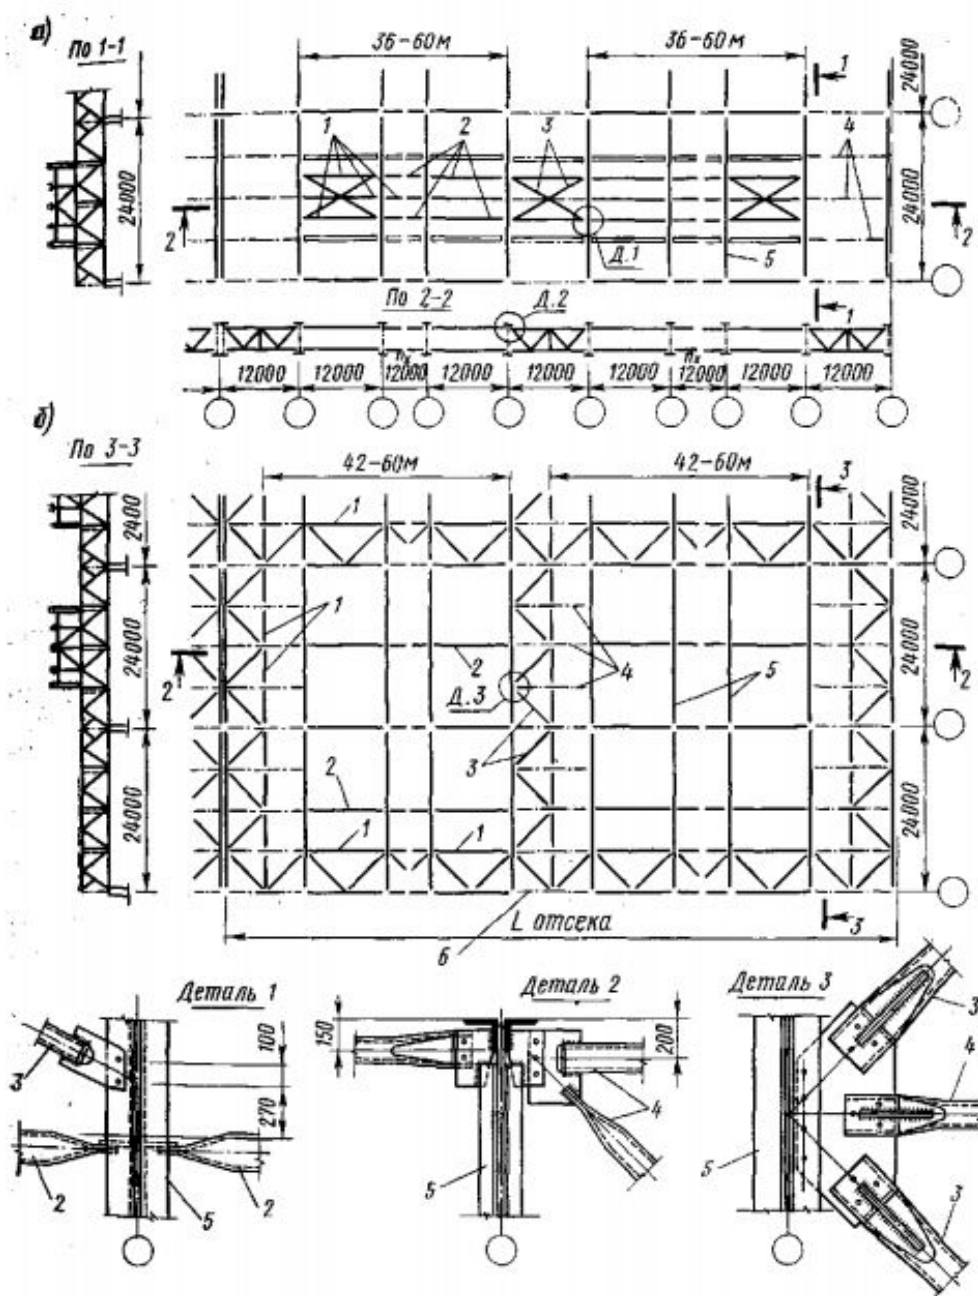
Пример решения связей в покрытии со стальными фермами:
